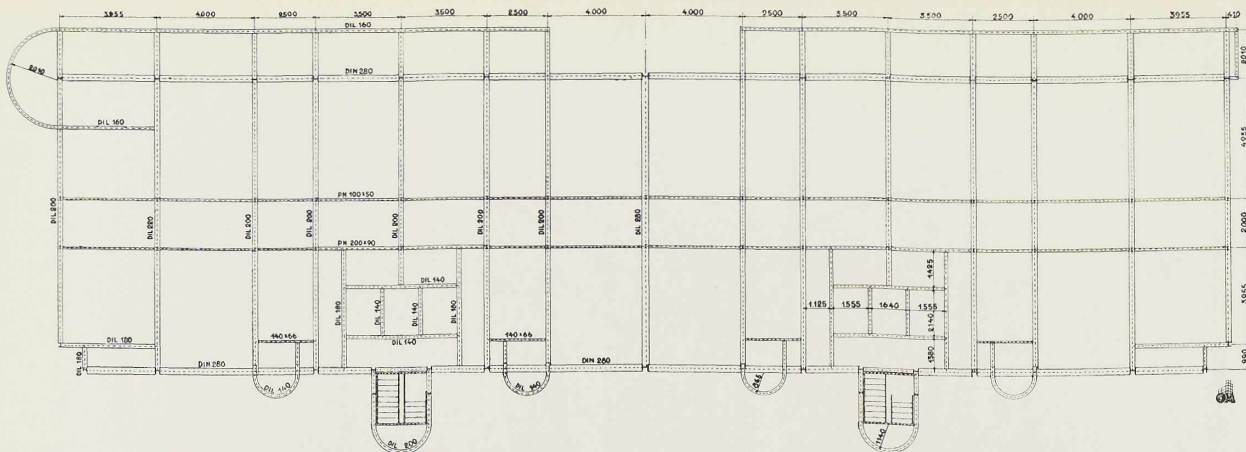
Plan d'étage de l'ossature métallique. On note les balcons et les cages d'escaliers en porte-à-faux.
